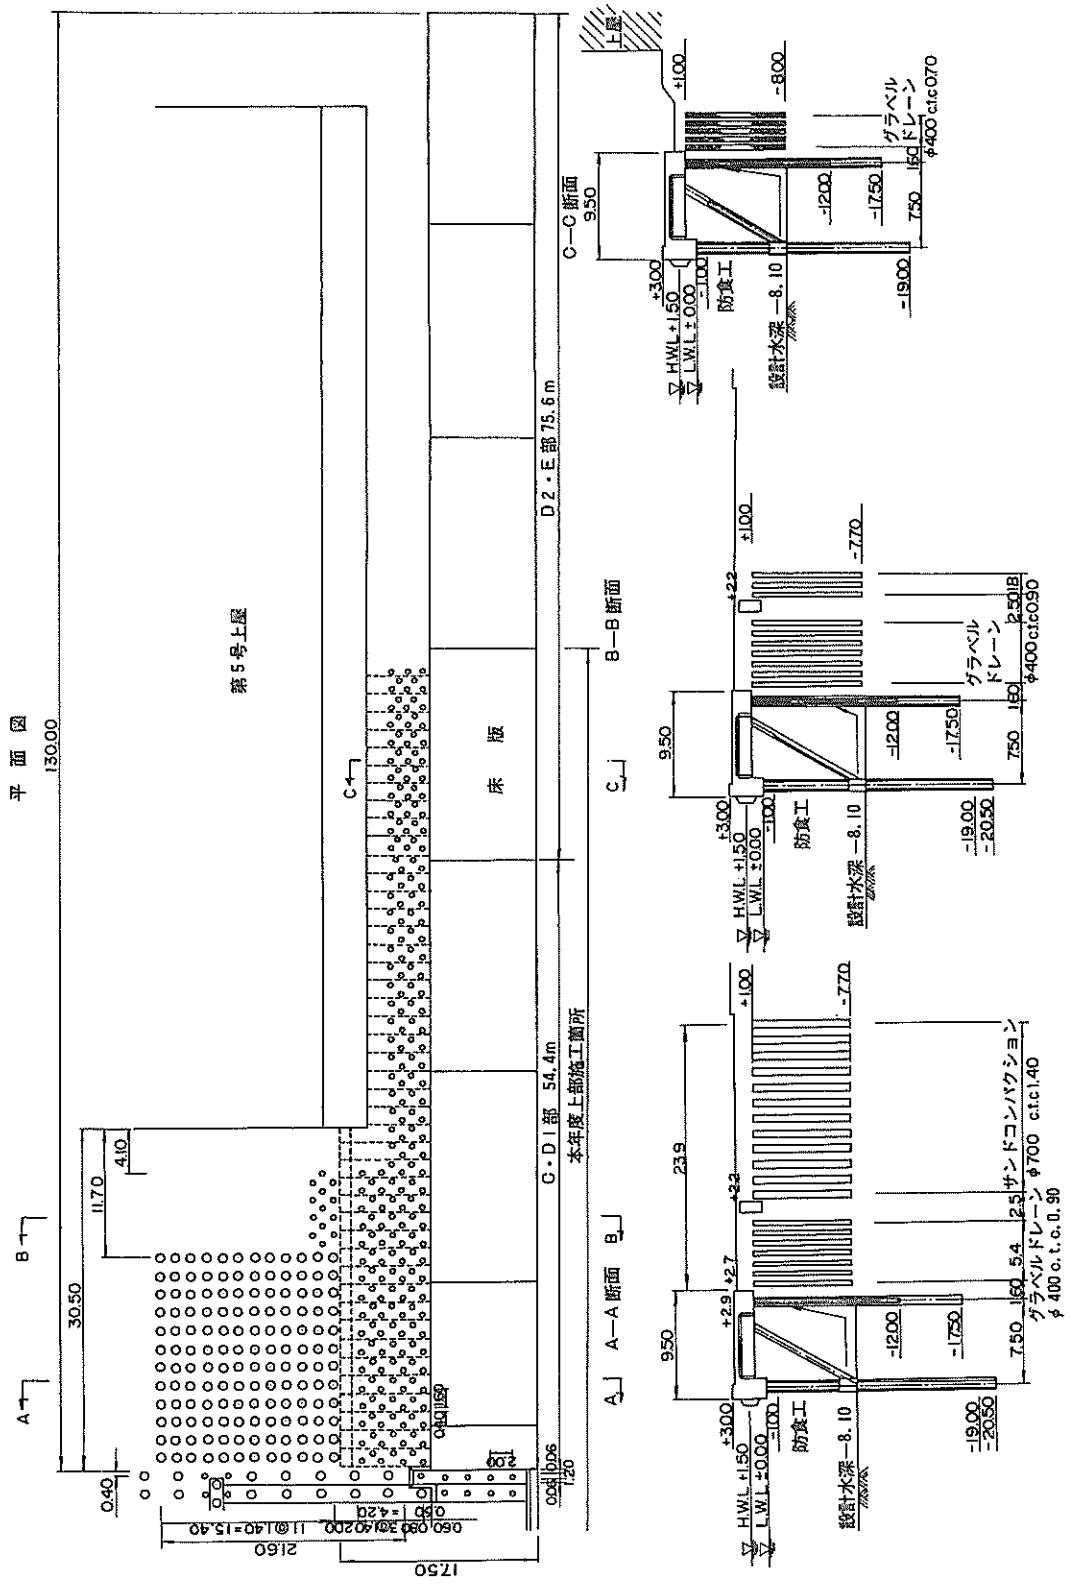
波状化対策工平面図（中央埠頭地区、③第5バース（-7.5m））
